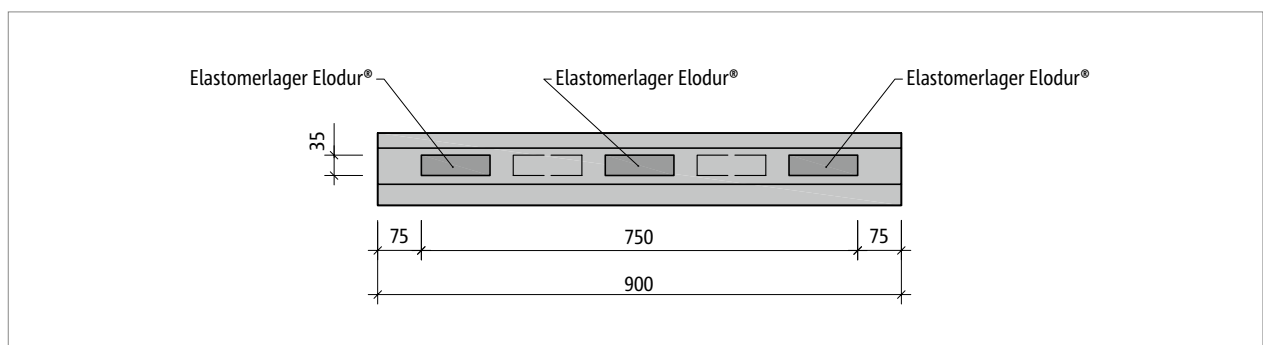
Schöck Tronsole® BL, BZ: Grundriss, beispielhafte Darstellung Tragstufe V1, Länge 900 mm
